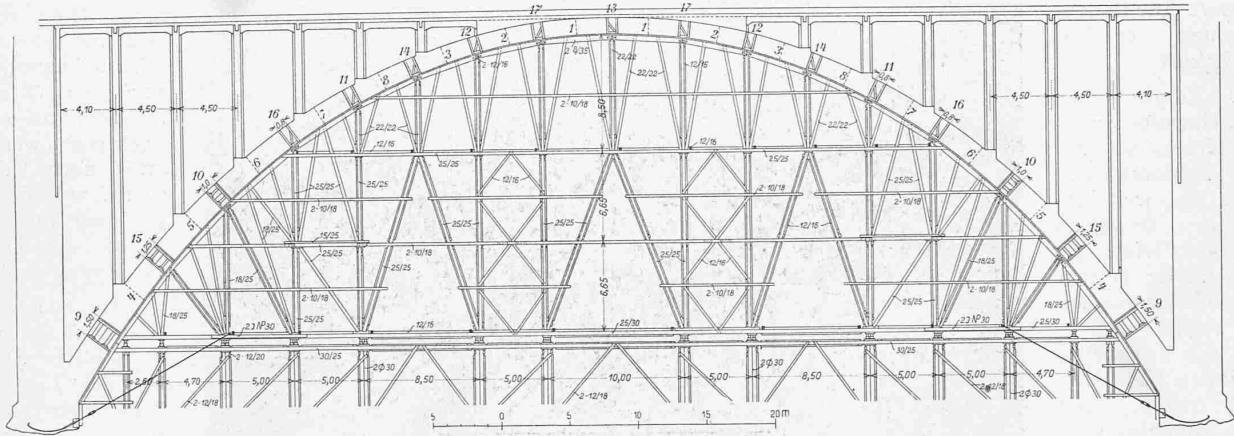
Ansicht des Hauptbogens auf dem obern Teil des Lehrgerüsts mit der Lamelleneinteilung für die Betonierung. — Masstab 1 : 500.
